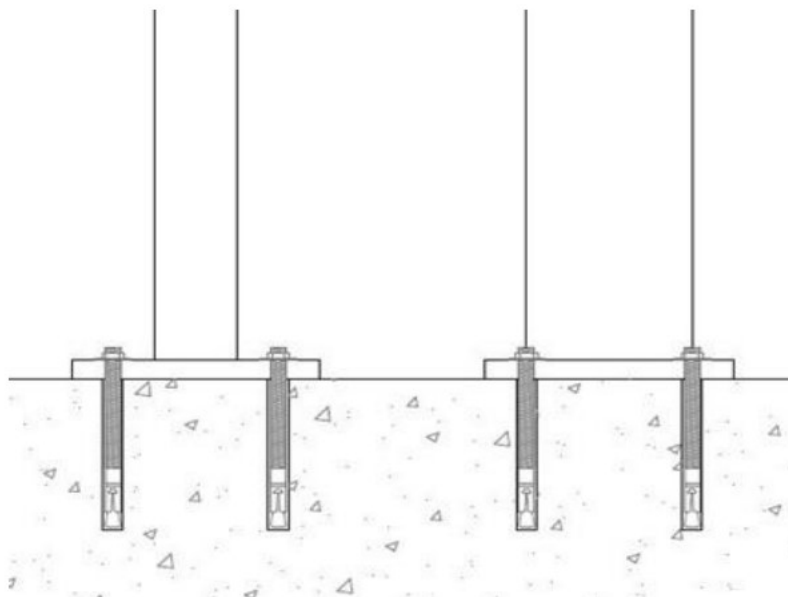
Detalhe fixação montante na base - chumbador mecânico
